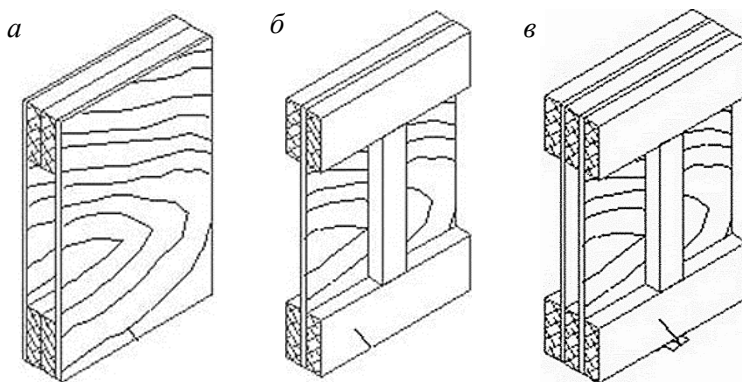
Типы клефанерных балок с плоской фанерной стенкой:
